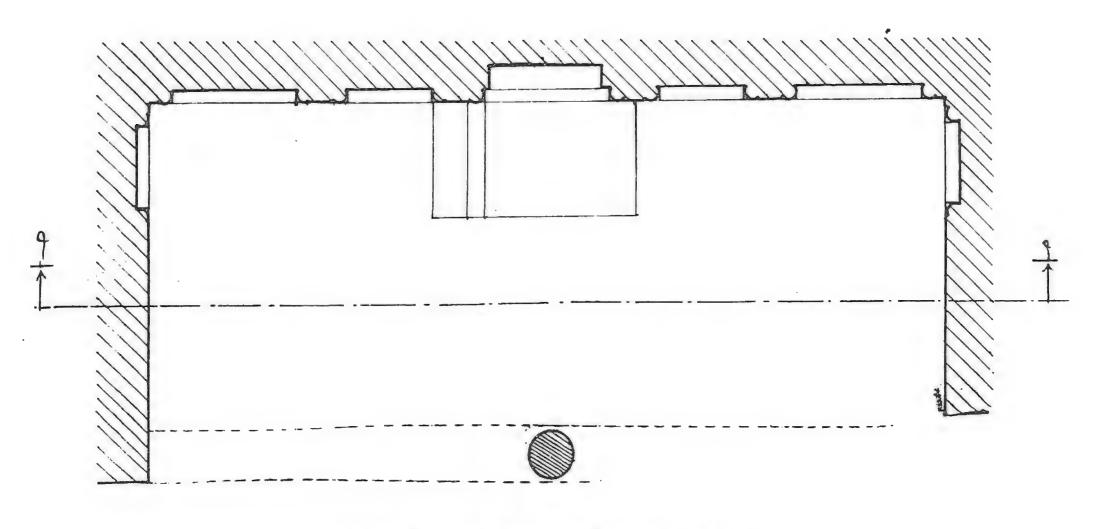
مسقط أفقى لحوض قجماس الأسحاقي
